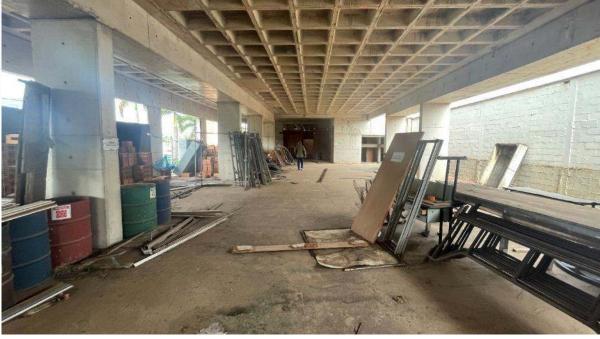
Sala 1 do pavimento térreo.
